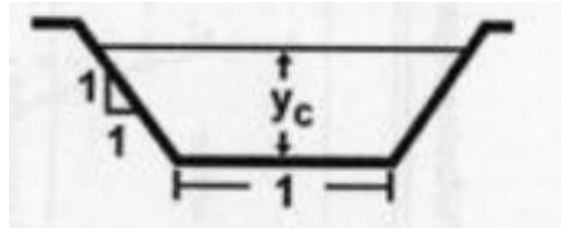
Sección transversal del problema planteado (Villón, 1995)
